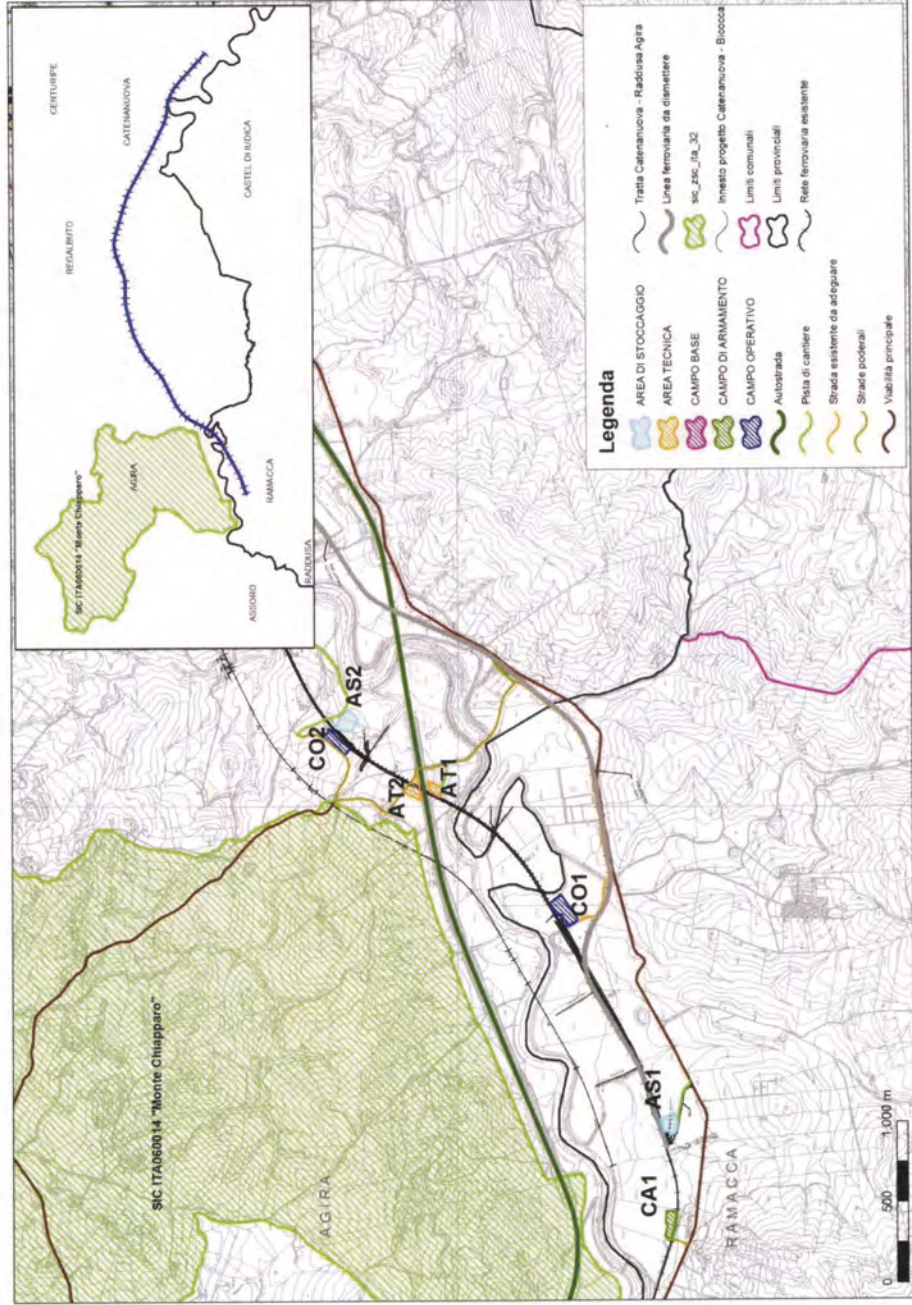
Localizzazione delle aree e della viabilità di cantiere rispetto al SIC ITA060014 "Monte Chiapparo"
